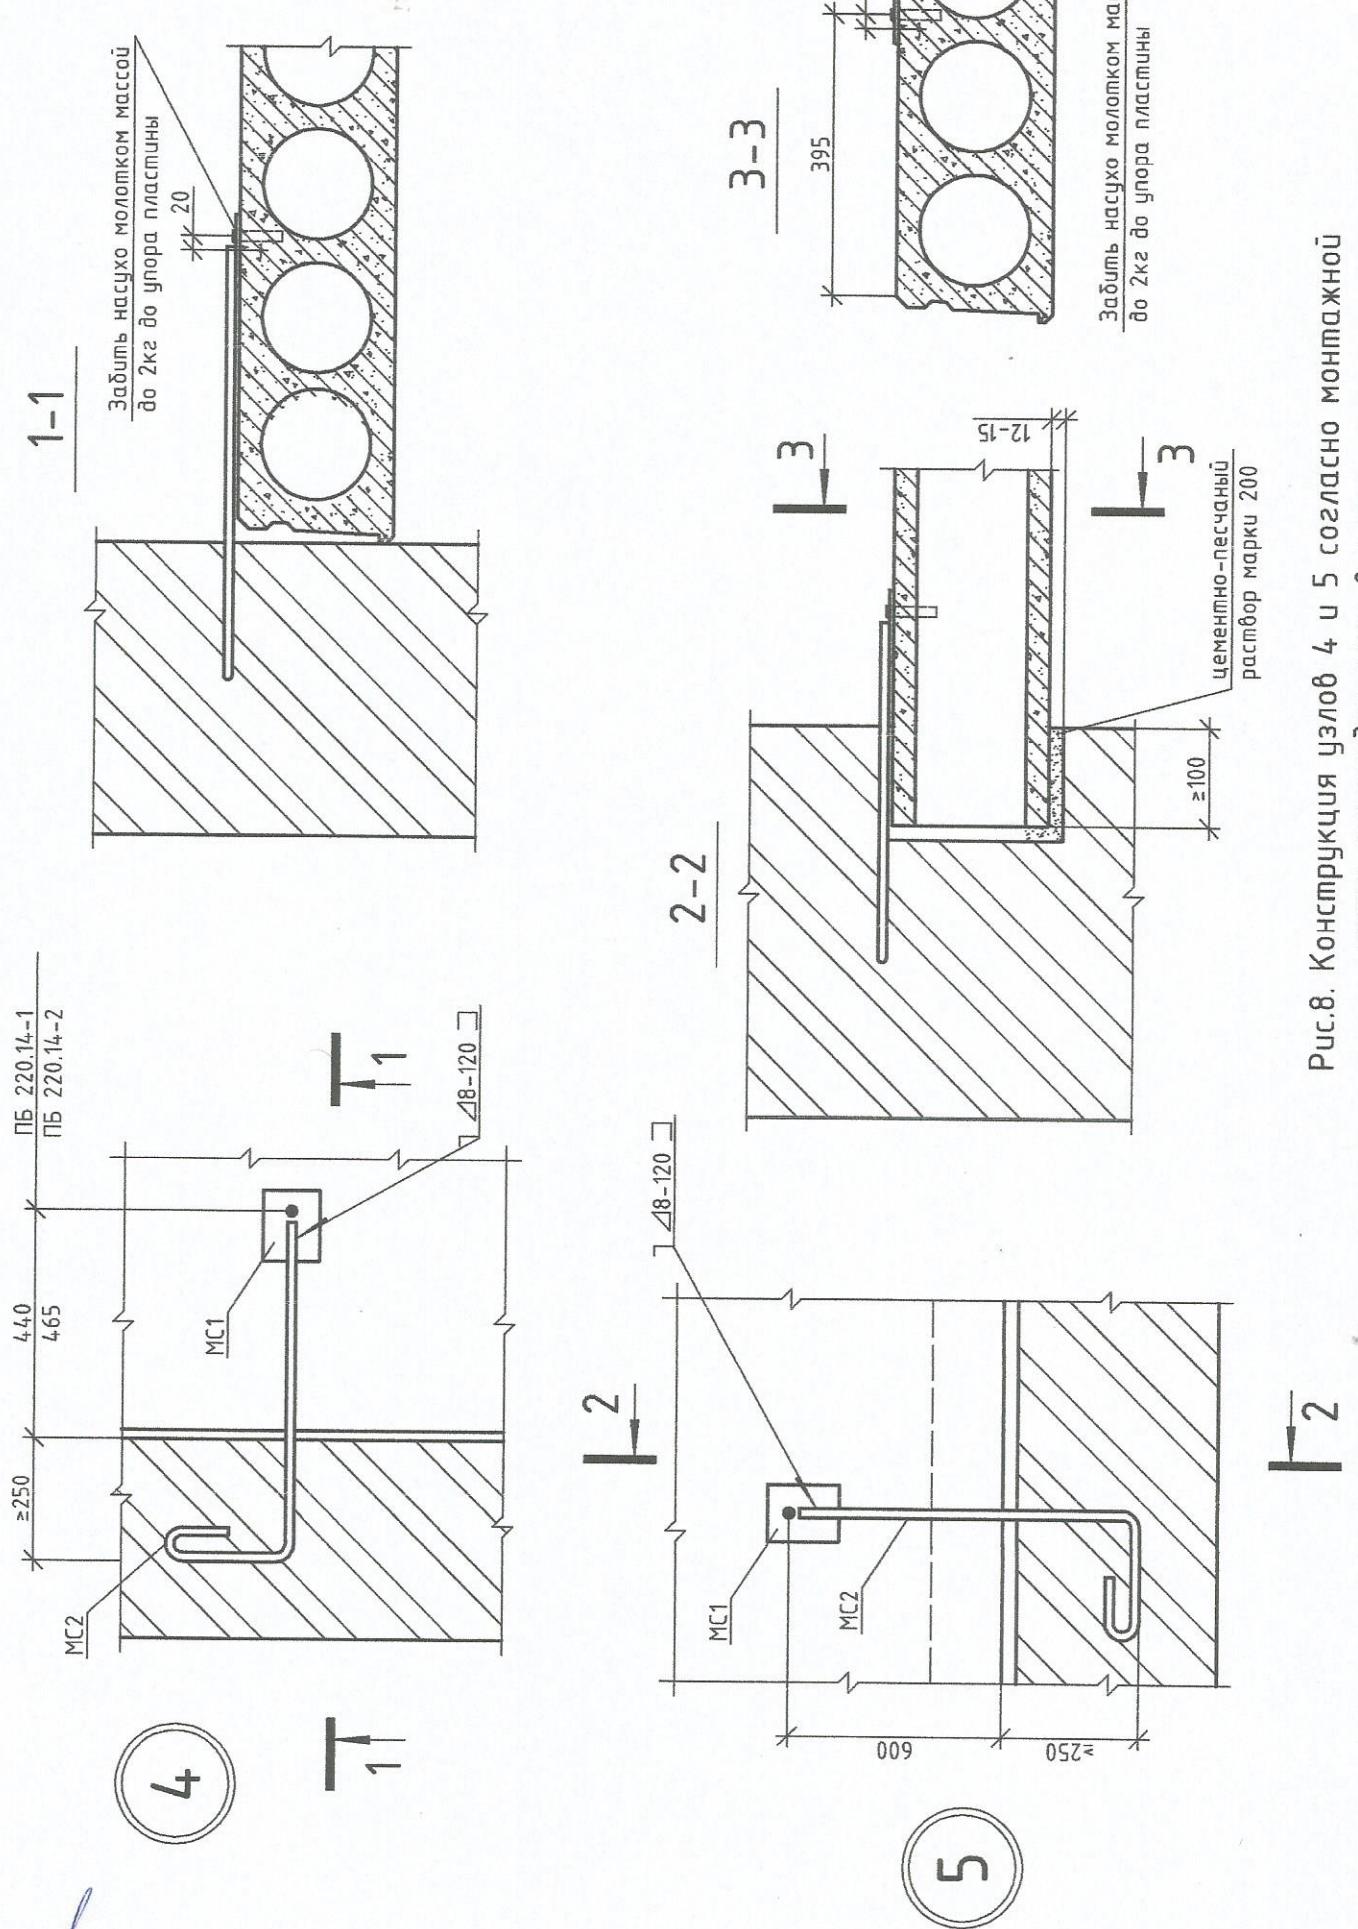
Конструкция узлов 4 и 5 согласно монтажной схеме раскладки плит в перекрытиях
